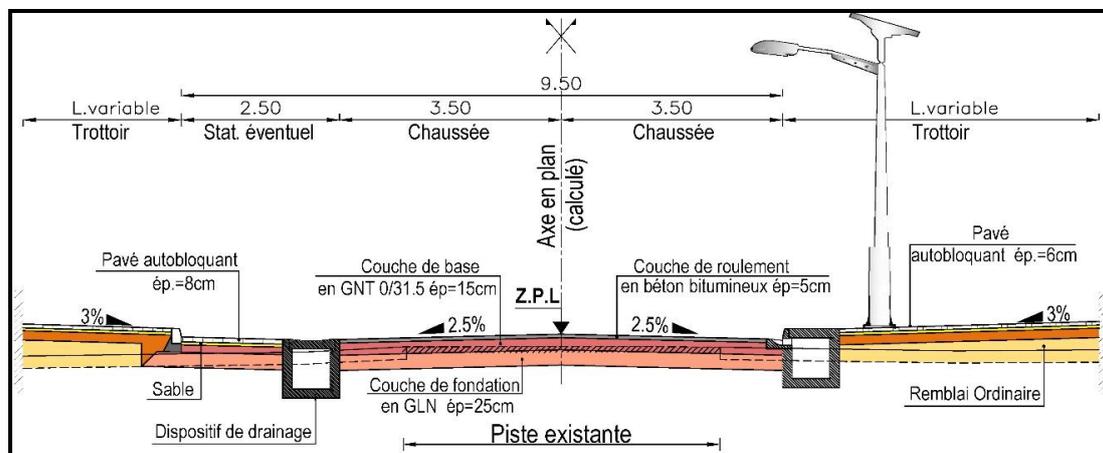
Profil en travers type de la voie n°2 d'accès aux sites touristiques de Ouidah
